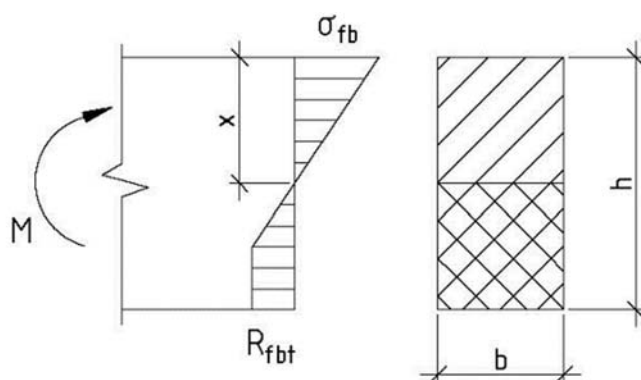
Схема усилий и эпюра напряжений в сечении, нормальном к продольной оси изгибаемого элемента прямоугольного сечения без арматуры при его расчете на прочность
